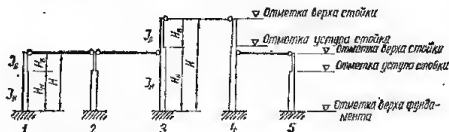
Расчетная схема многопролетного поперечника с ригелями в разных уровнях.
